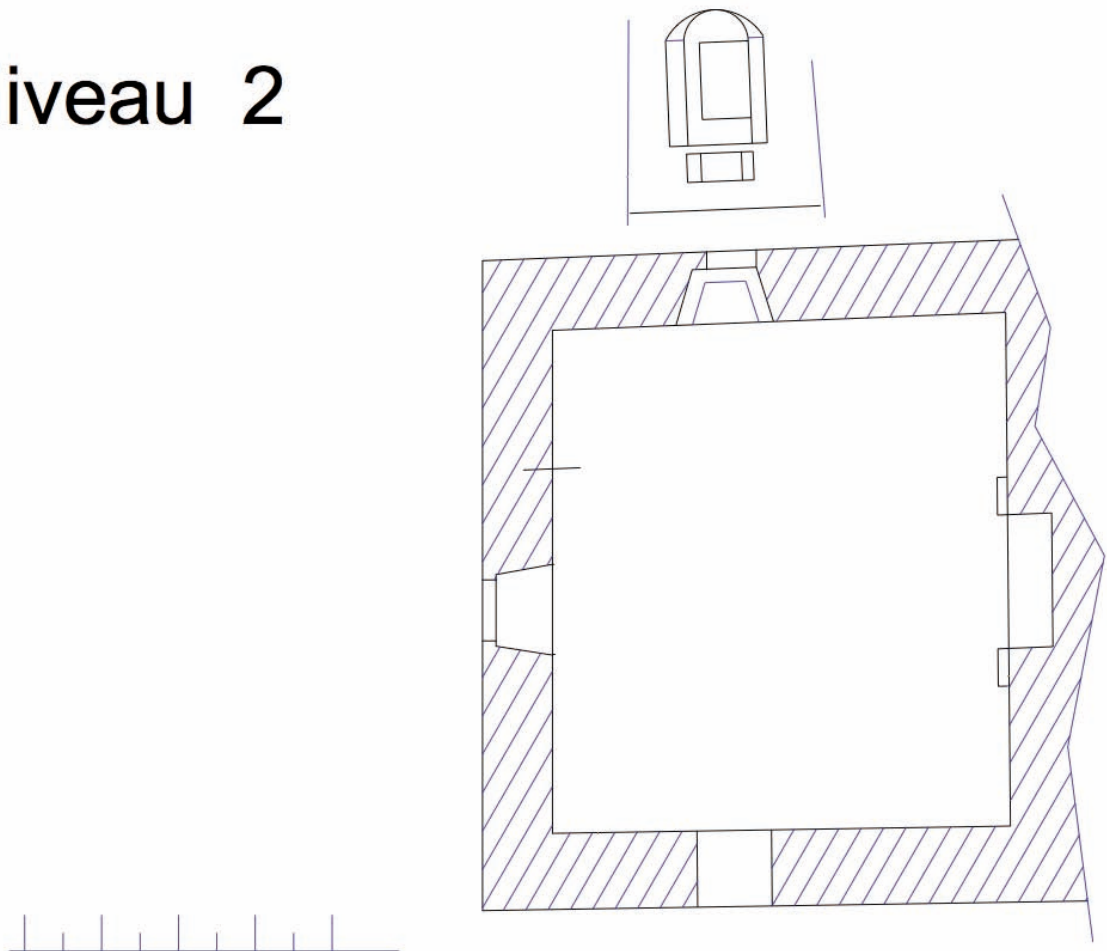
Plan du niveau 2 (DAO : P. Lhomme)
